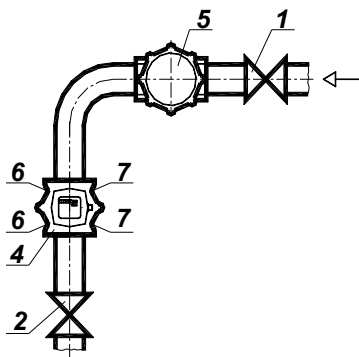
Схема монтажа счетчика (безбайпасная) на вертикальном газопроводе
